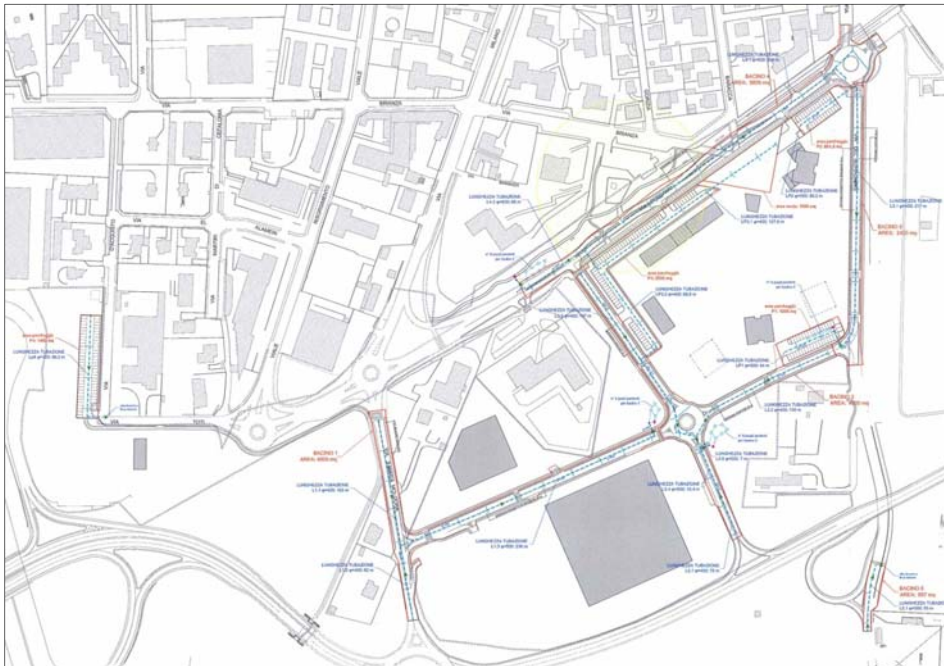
Planimetria generale della rete fognaria acque bianche in progetto
